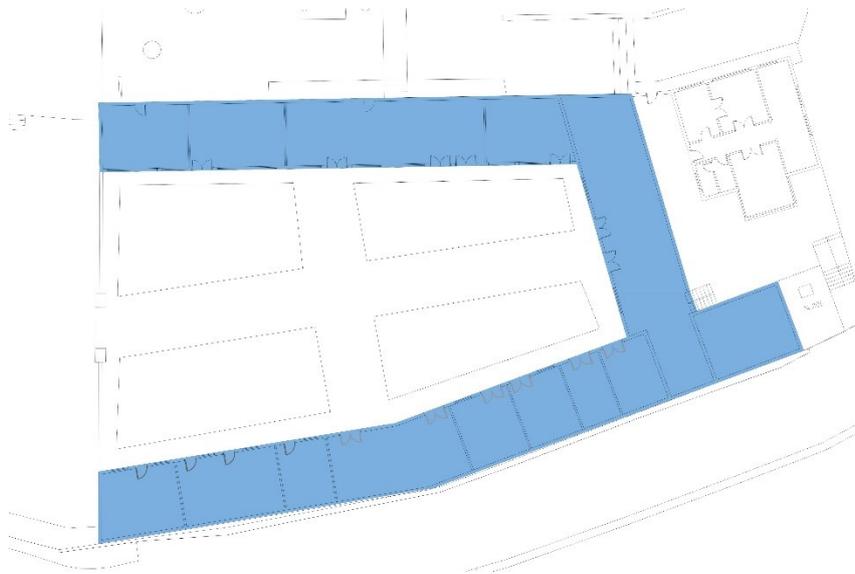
Planta de los pabellones de laborterapia.
